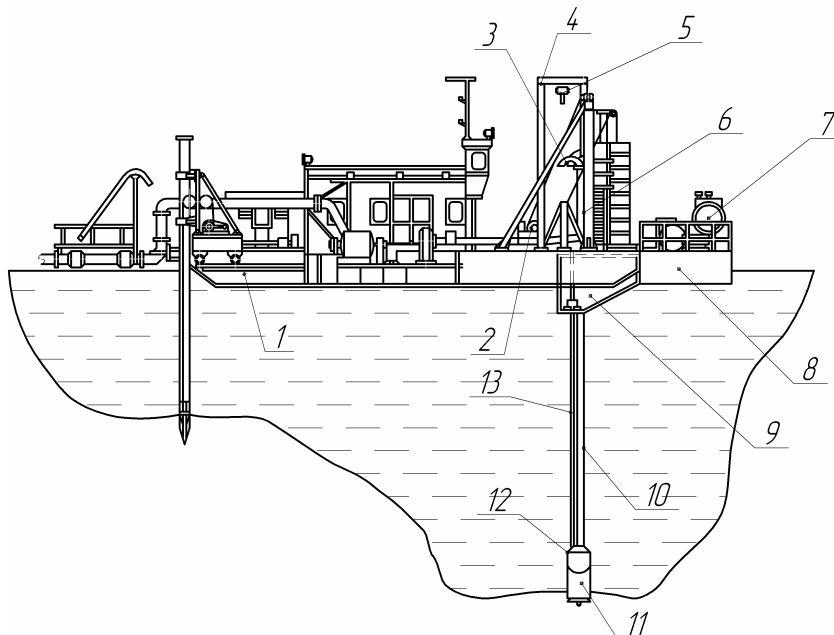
Схема ерліфтно-землесосної установки: 1 – земснаряд; 2 – ручна лебідка; 3 – зливна труба; 4 – портал; 5 – тельфер; 6 – повітровідокремлювач; 7 – компресор; 8 – додатковий плавзасіб; 9 – зумпф; 10 – підйомний трубопровід; 11 – ґрунтозабірний пристрій; 12 – трубопровід розмивання ґрунту; 13 – повітроподаючий трубопровід
